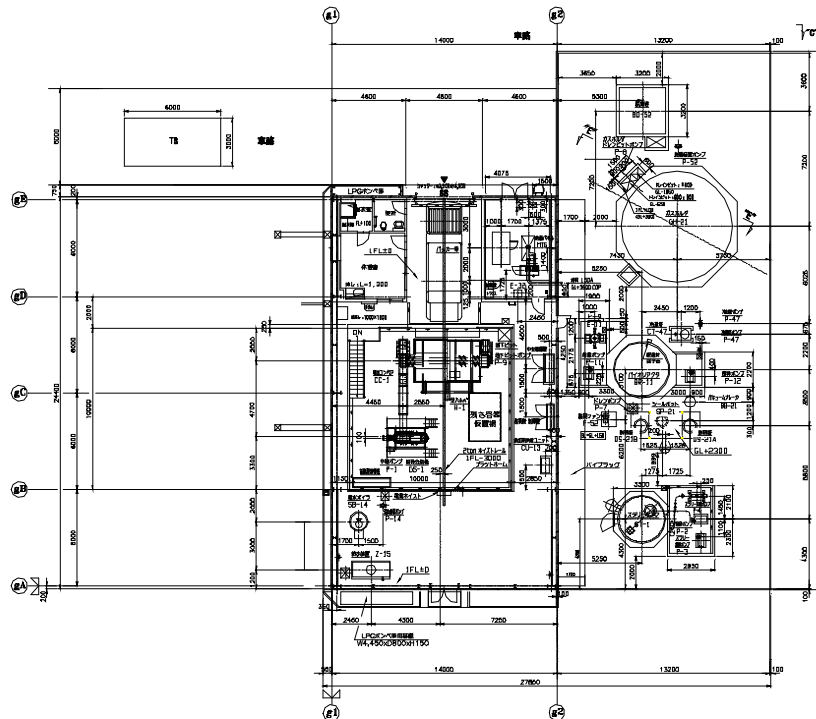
本システムの平面図 (反応槽 1 基の場合)
